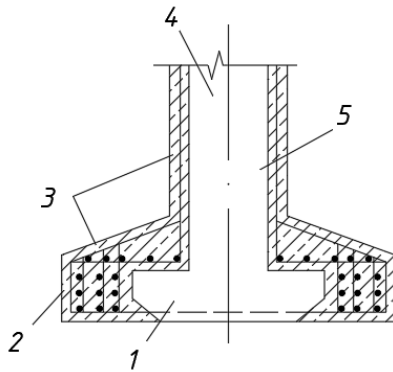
Підсилення фундаменту залізобетонною «сорочкою»:
